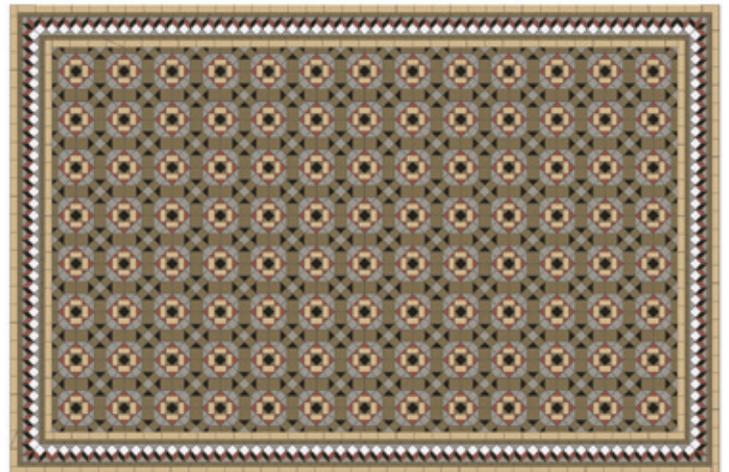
Villa Morris. Pavimento de cerámica Nolla de una habitación de la primera planta. Fuente: Autores.
